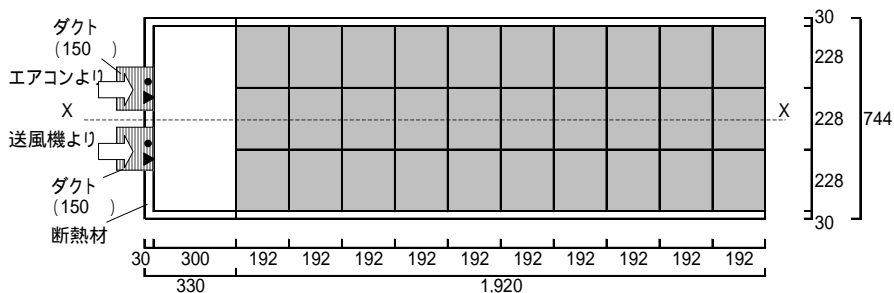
(a) 蓄熱体平面図 (蓄熱レンガ)
